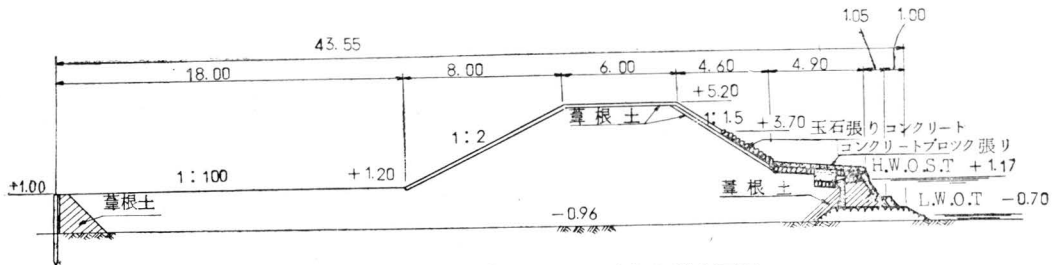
鍋田干拓海岸堤(船溜り部)標準断面図
